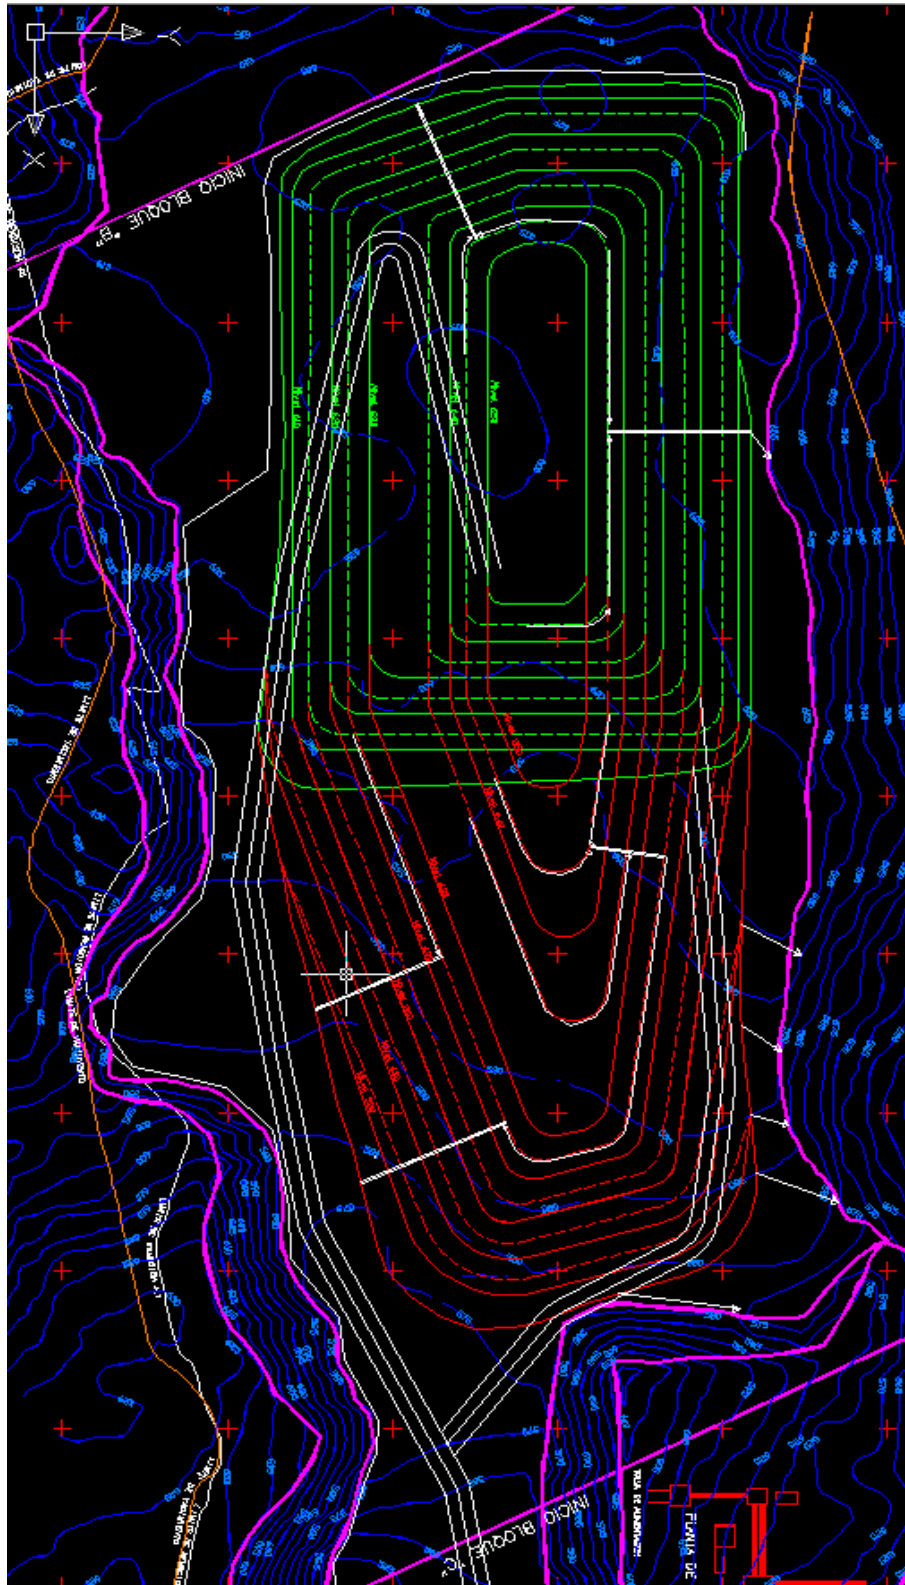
Proyección de las escombreras en el pit final de la mina
